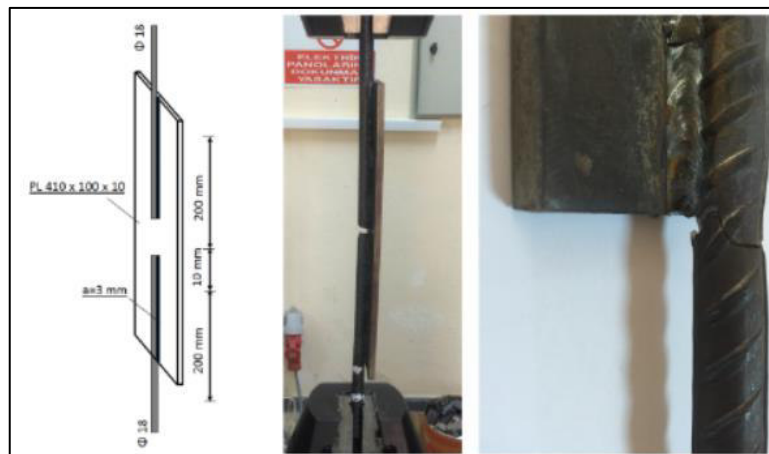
Ensayo de tracción en barras de refuerzo de 18 mm de diámetro soldadas por ambos lados a la placa de acero.
